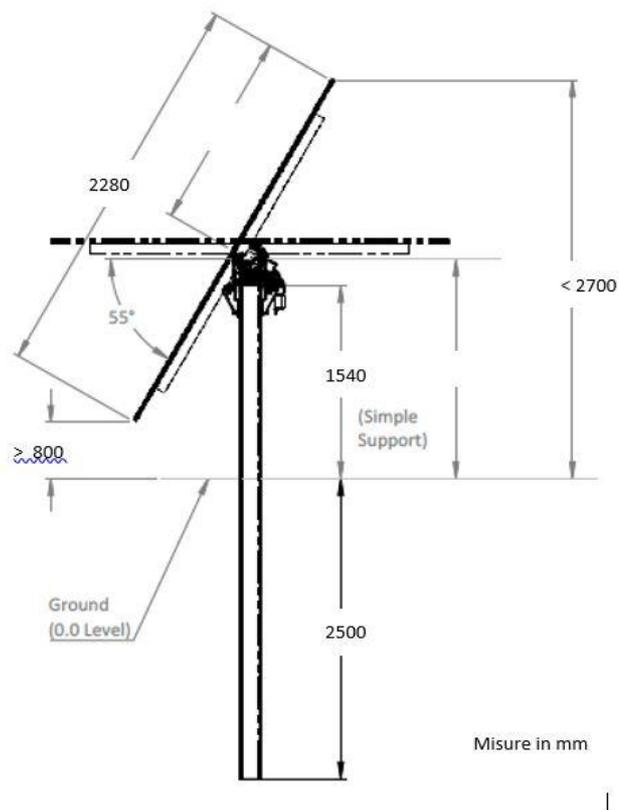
Schema della struttura – sezione trasversale su montante
